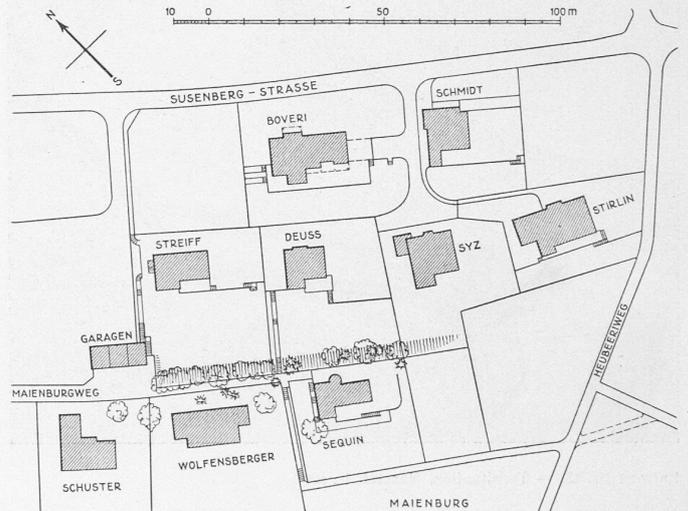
Lageplan der Häusergruppe oberhalb der Maienburg. — 1 : 2000.
